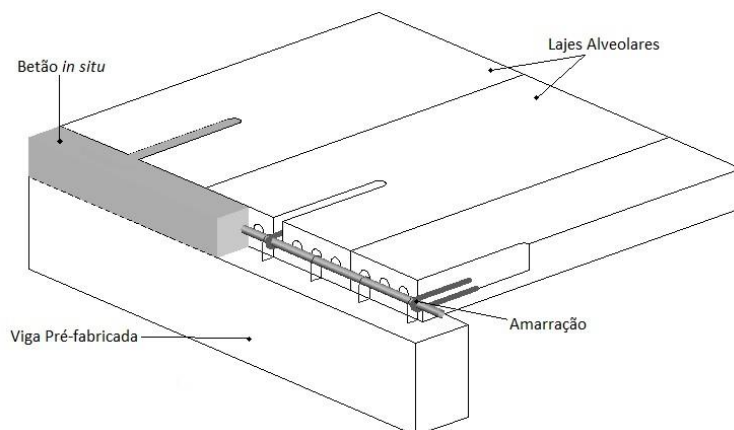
Ligação Laje – Viga de extremidade com amarração
